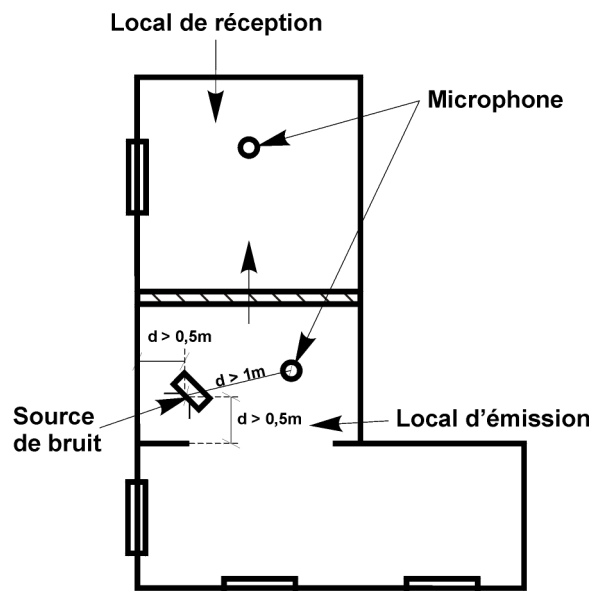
Mesurage de l'isolement horizontal entre locaux - Cas de locaux séparés par une baie libre (par exemple, cas d'une cuisine ouverte sur la pièce principale).
